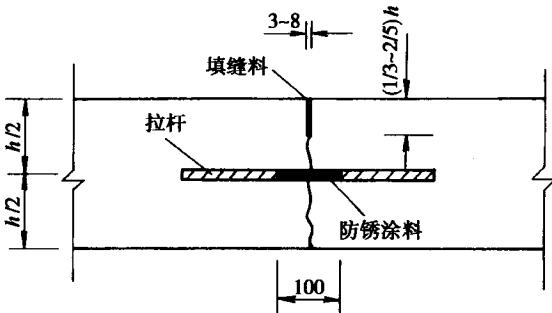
纵向缩缝构造(尺寸单位:mm)
